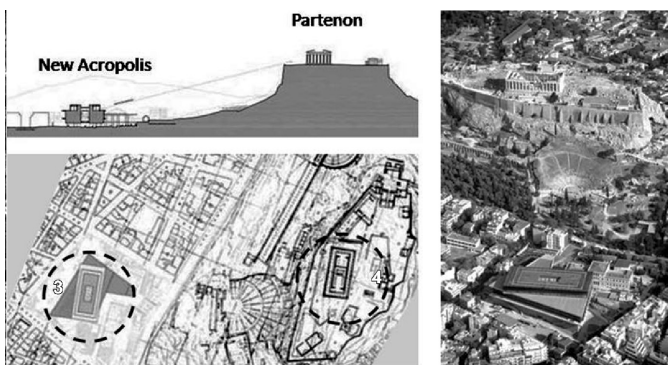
Corte, planta e vista do Museu New Acropolis de Bernard Tschumi, 2001-2009. O museu foi projetado para abrigar peças remanescentes do Partenon, muitas das quais foram levadas para a Inglaterra no século XVIII.
